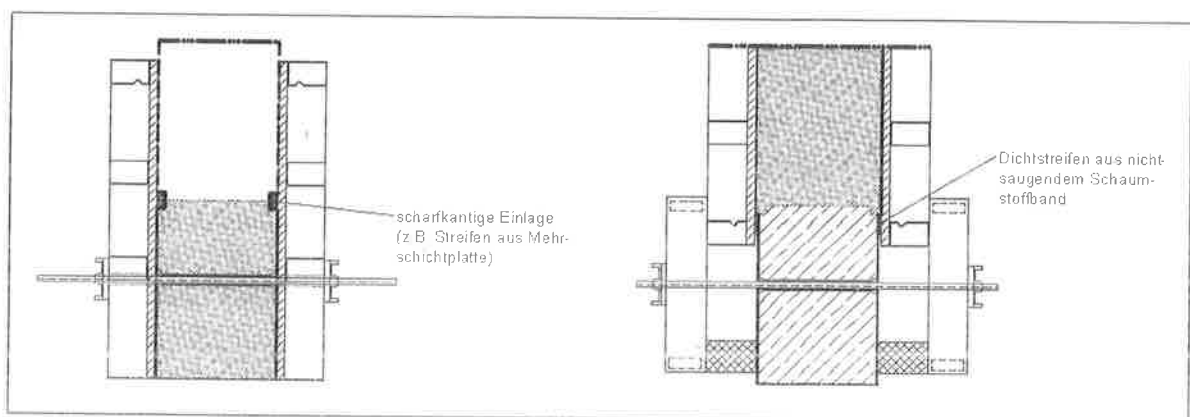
Flächenbündige Arbeitsfuge; links: erster Betonierabschnitt; rechts: zweiter Betonierabschnitt
